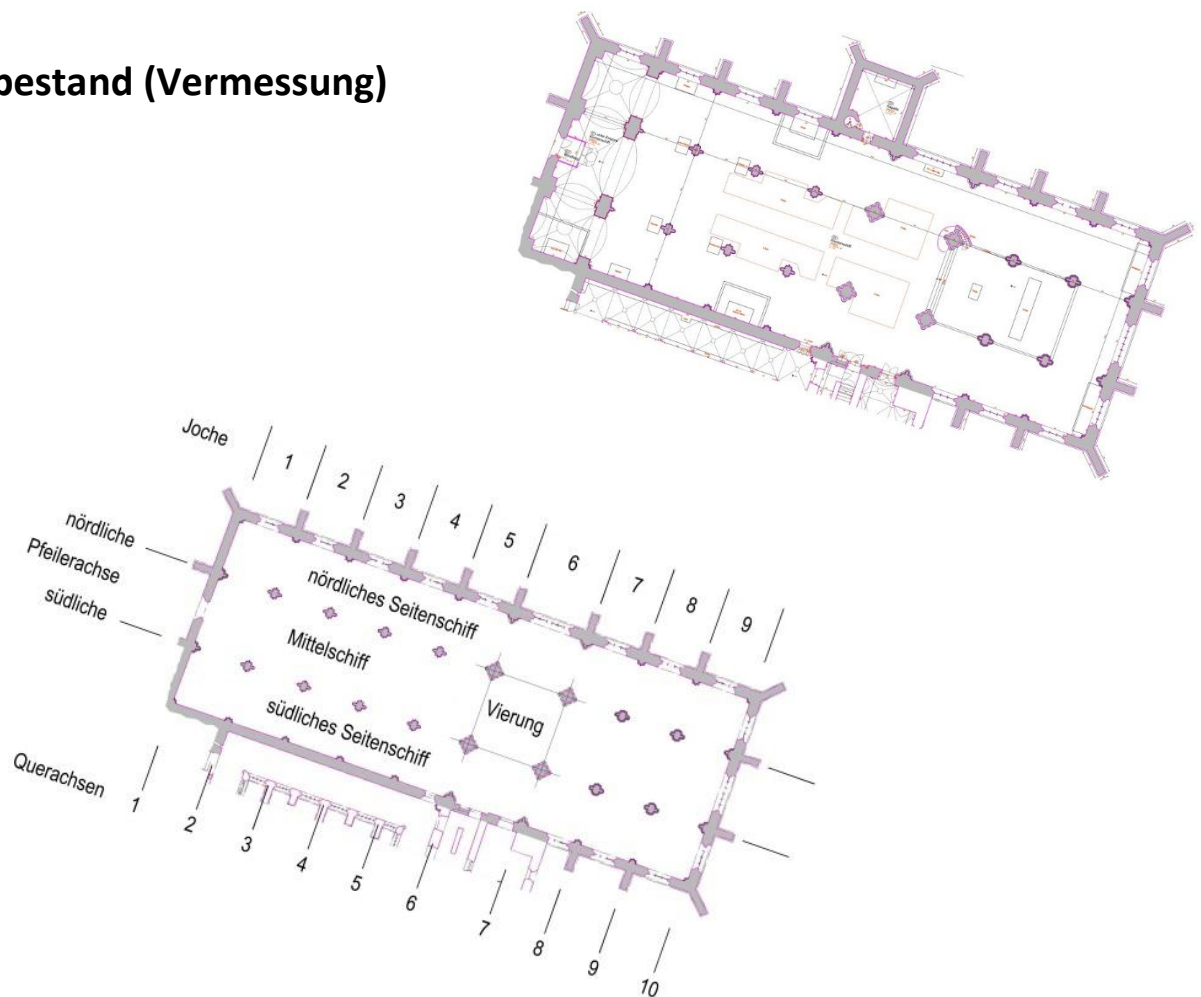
Münster Neubeurg, geodätisch erfasster Grundriss (Aufnahme in einem lokalen System,²² Plan vom Verfasser genordet). – Für die weiteren Betrachtungen wurde der Plan auf Wände und Pfeiler reduziert und mit
